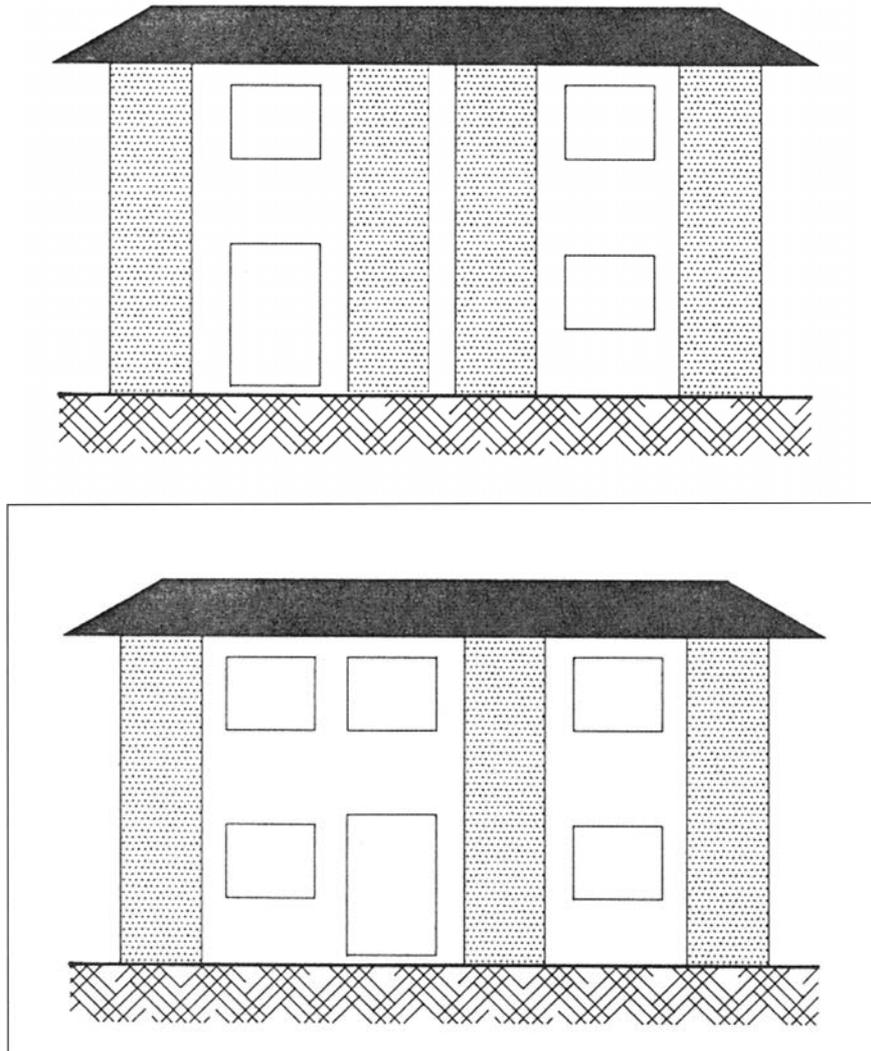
Exemples d'implantations minimales des panneaux de contreventement dans une maison r+1
